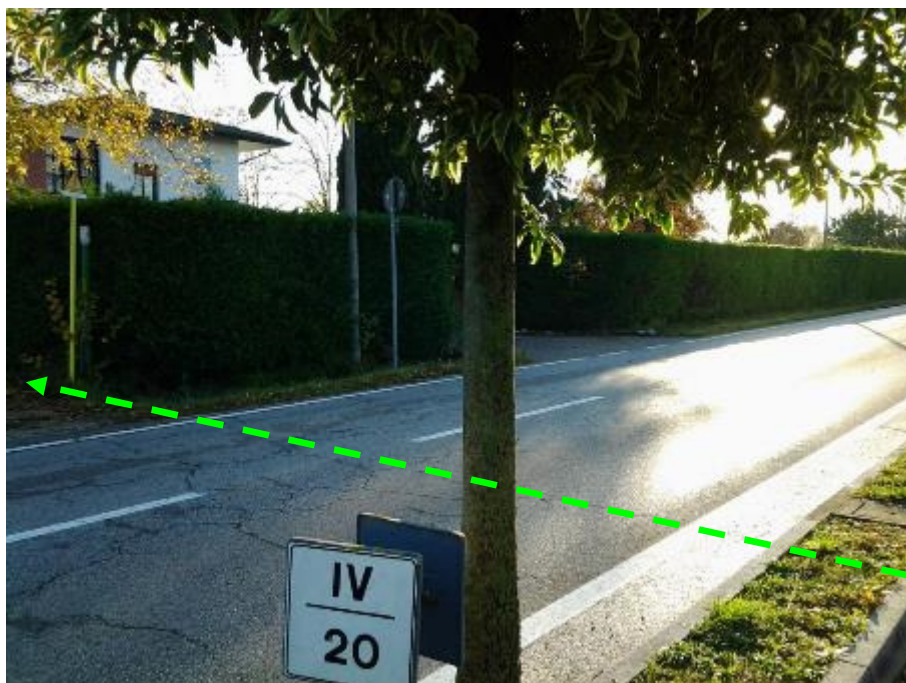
ATTRAVERSAMENTO S.P. N. 7
